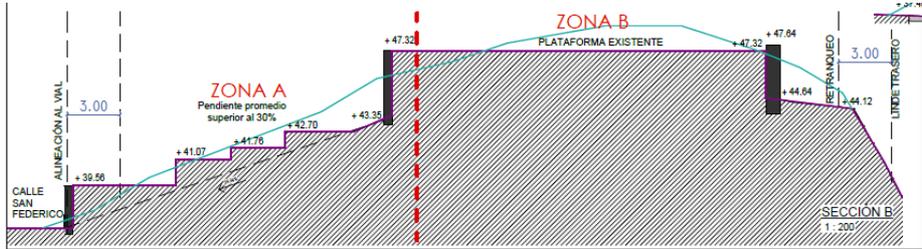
Sección transversal de parcela indicando Zonas A y B
